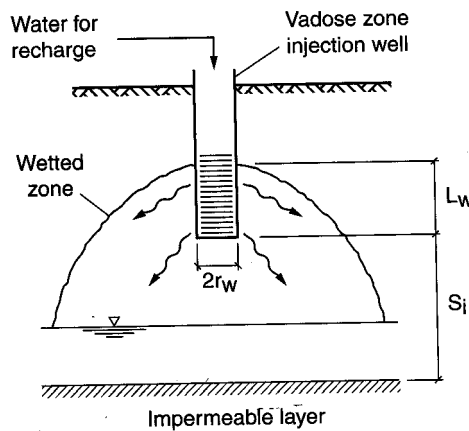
Esquema de um poço seco executado na zona vadosa
